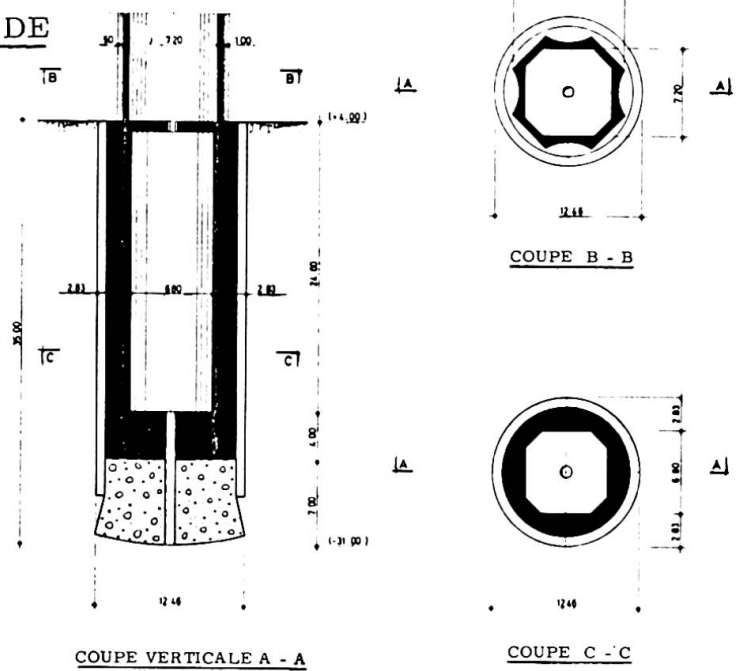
FONDATIONS DU PONT DE SALLINGSUND
